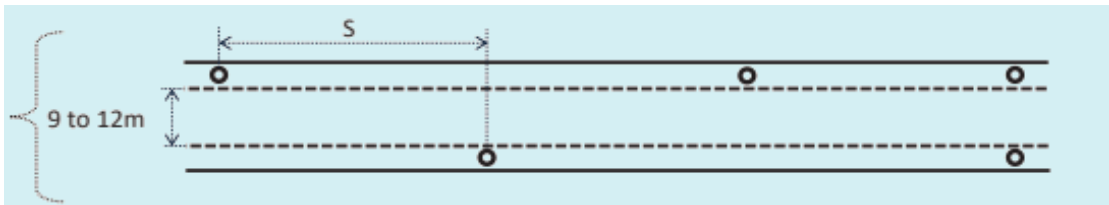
स्टॅगर्ड अरेंजमेंट (Staggered arrangement)
